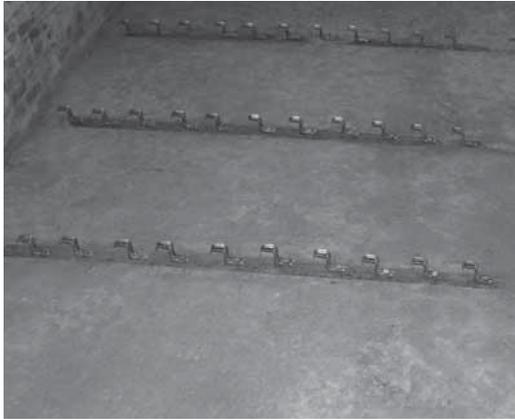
Vistas de refuerzo realizado en el forjado de planta cuarta.
